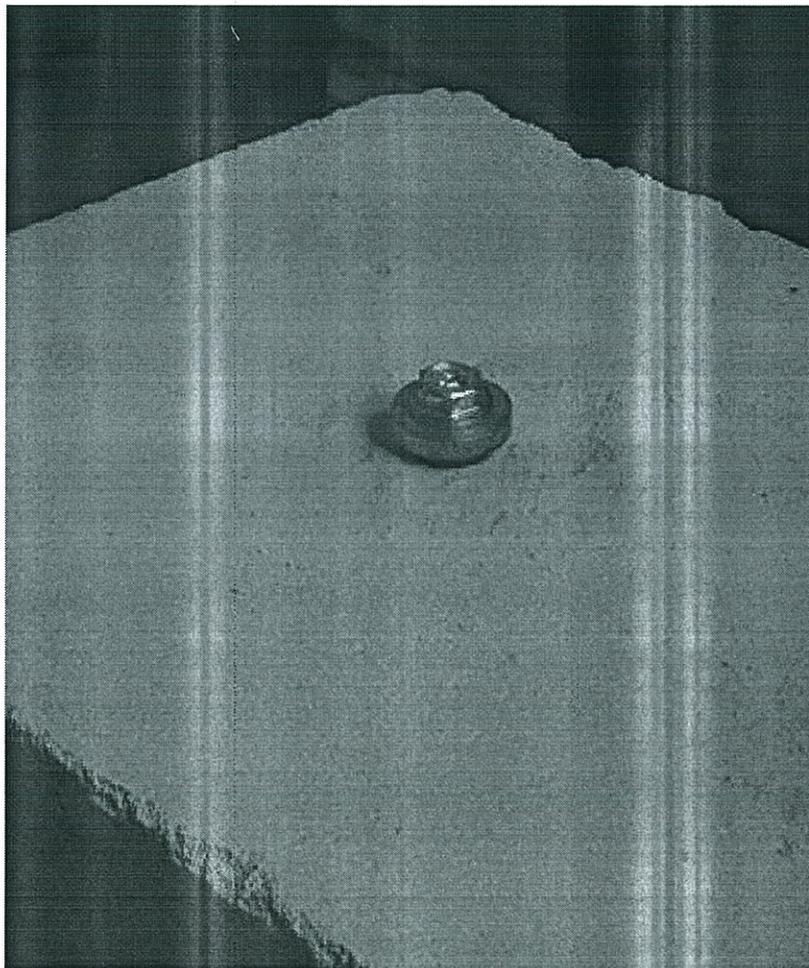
Анкер марки HRD, закреплённый в газобетонный блок, перед испытанием
